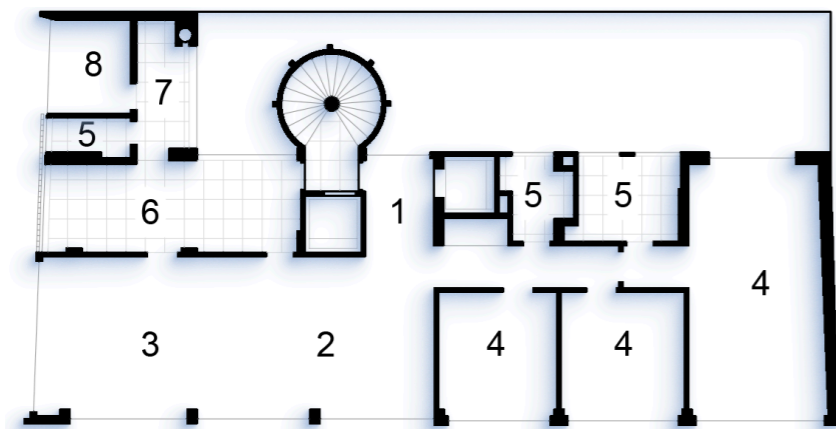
Redesenho Planta Térreo do Edifício Faial.
